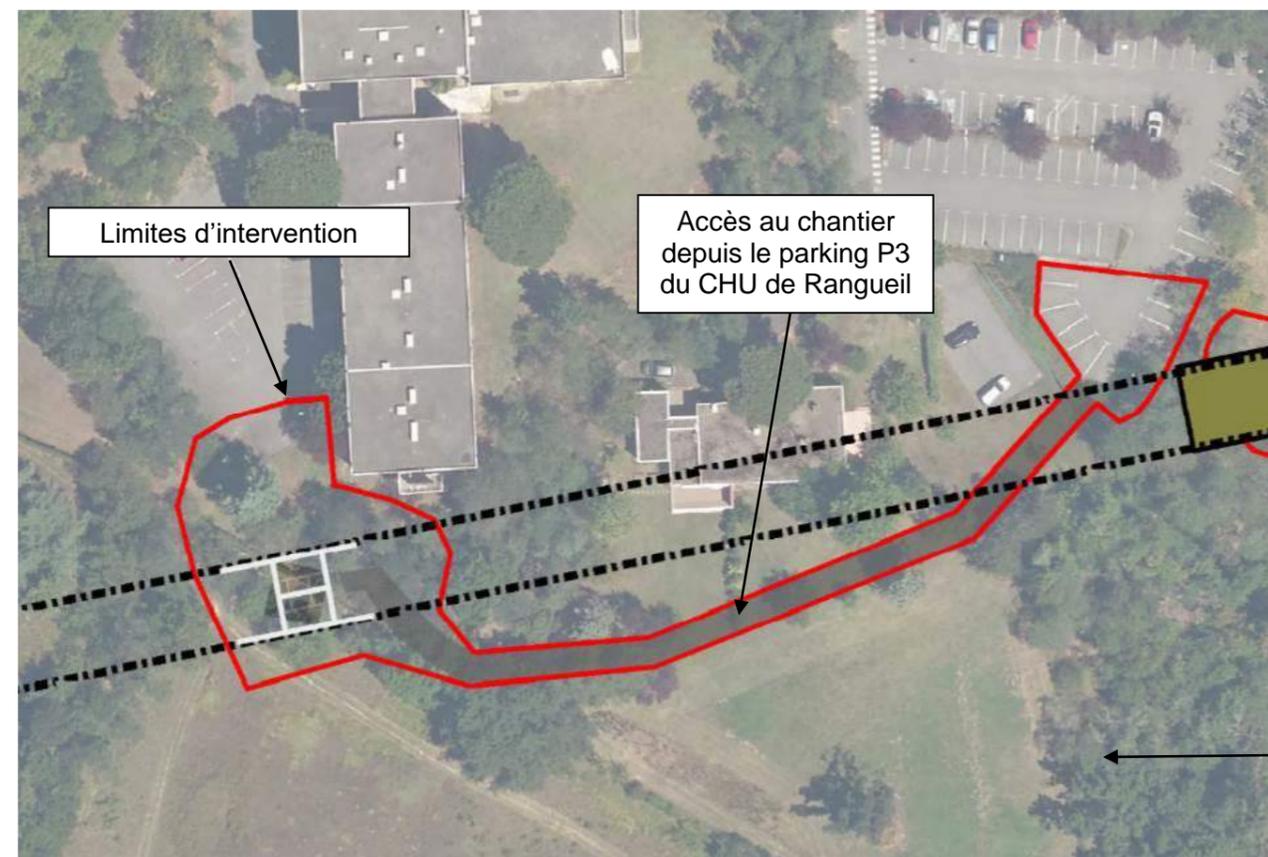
Plan de localisation des travaux de mise en place du P3 (source : Groupement POMA, 2017)
